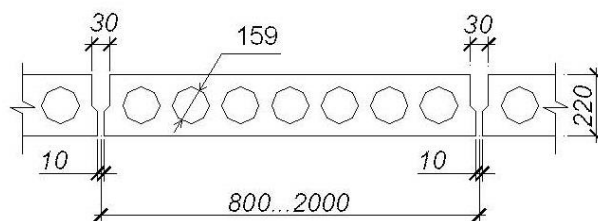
Переріз плити перекриття з круглими порожнинами
